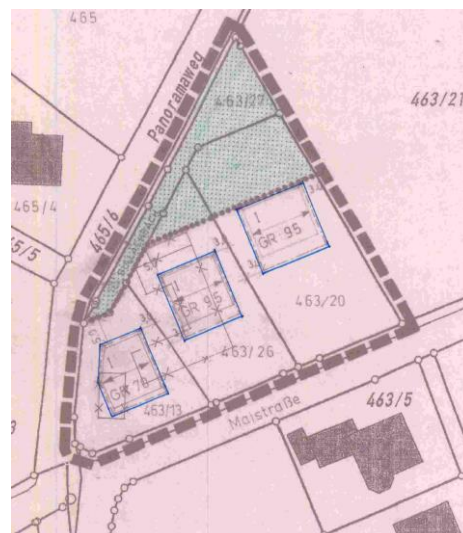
rechtskräftige 1. Änderung im westlichen Bereich
